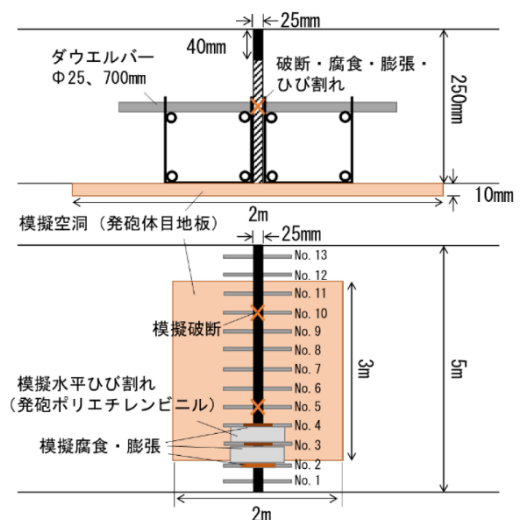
模擬損傷概要図(上:断面図、下:平面図)
